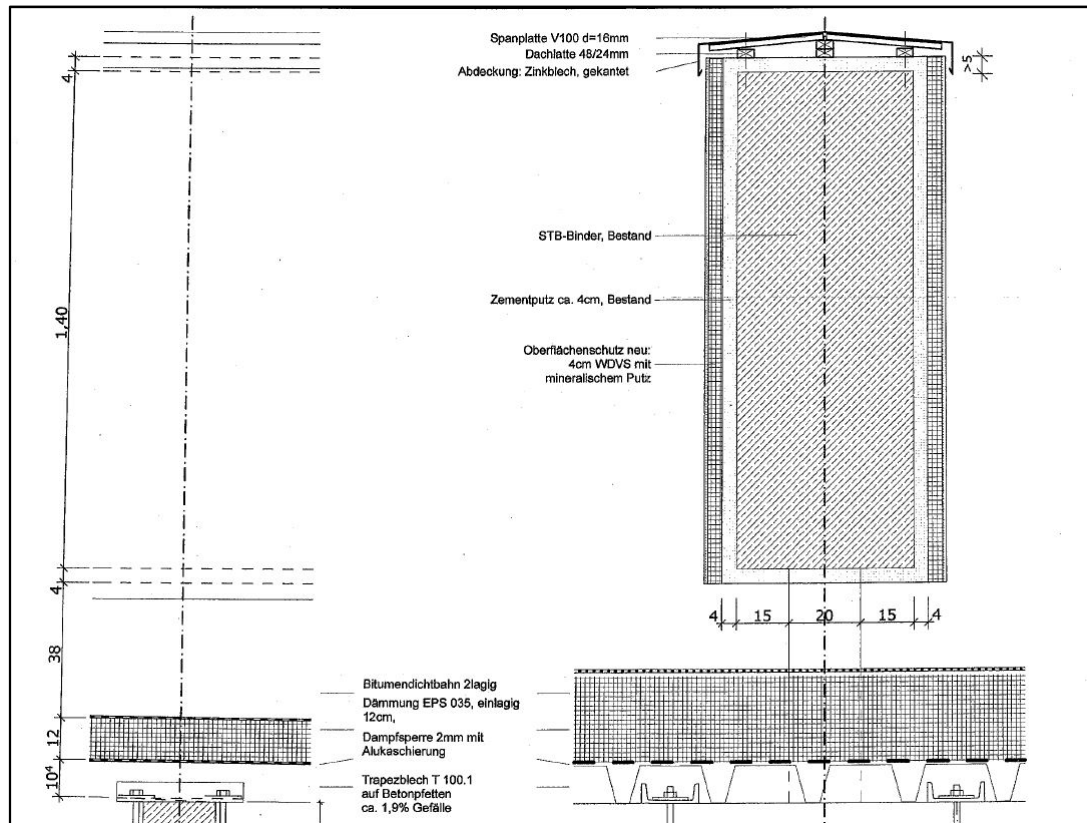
Ausführungspläne Beton- und Dachsanierung, Architektenbüro Klaus Bernardi (Theaterstr. 30-32, 52062 Aachen)
